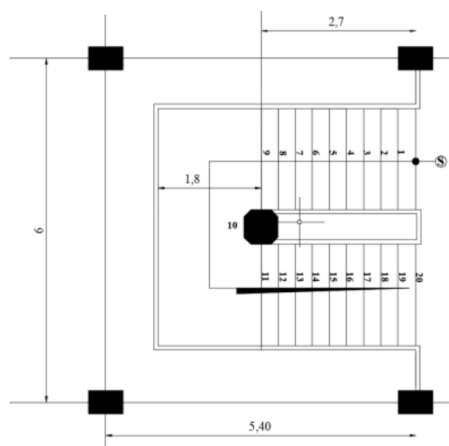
Configuración estructural de la losa en la cuarta planta alta
